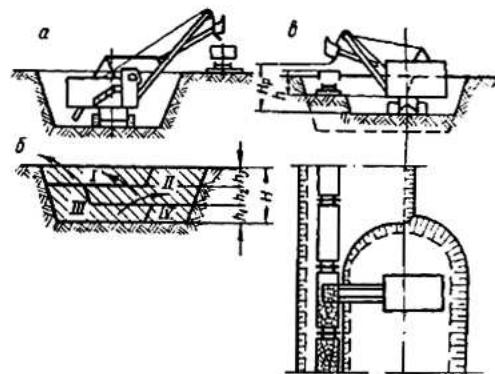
Проходка траншеи сплошным забоем с верхней погрузкой породы
